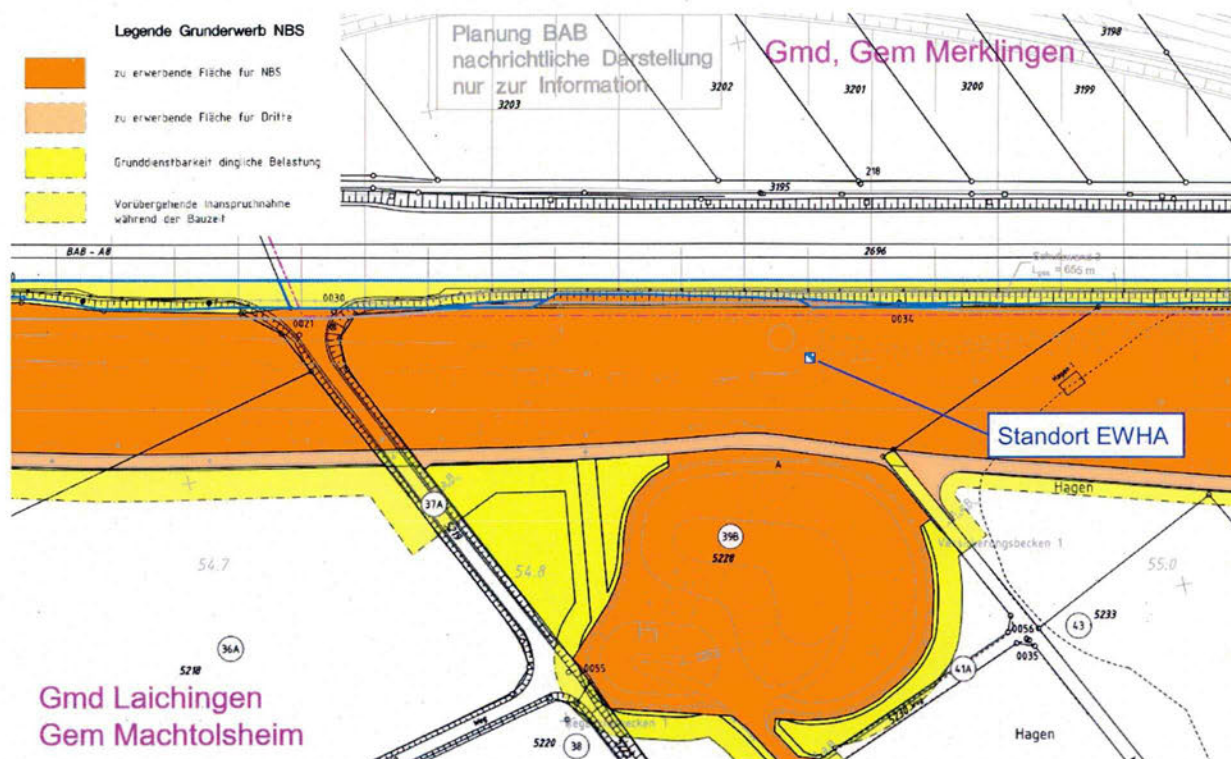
Auszug aus dem letztgültigen Grunderwerbsplan, Anlage DB 9.3, Blatt 3C, Stand 23.12.2016 (Teil des Planänderungsverfahrens „Abkommensschutz westliche Ortslage Widerstall“)
